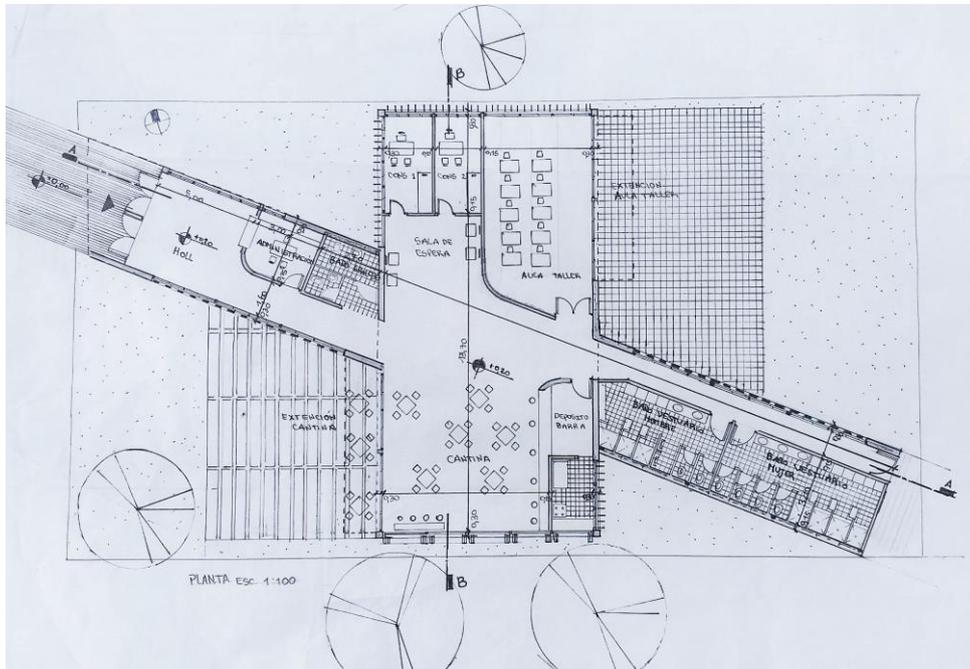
Planta de la Sede del Área de Deportes de la UNC.
